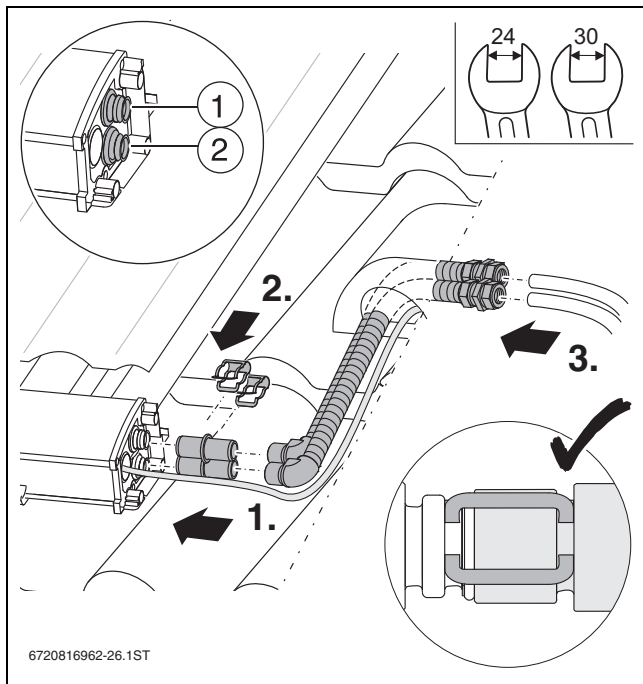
Anschlussrohre und Fühlerkabel durch das Dach führen, Darstellung ohne Dämmung (hier: gleichseitiger Anschluss)
